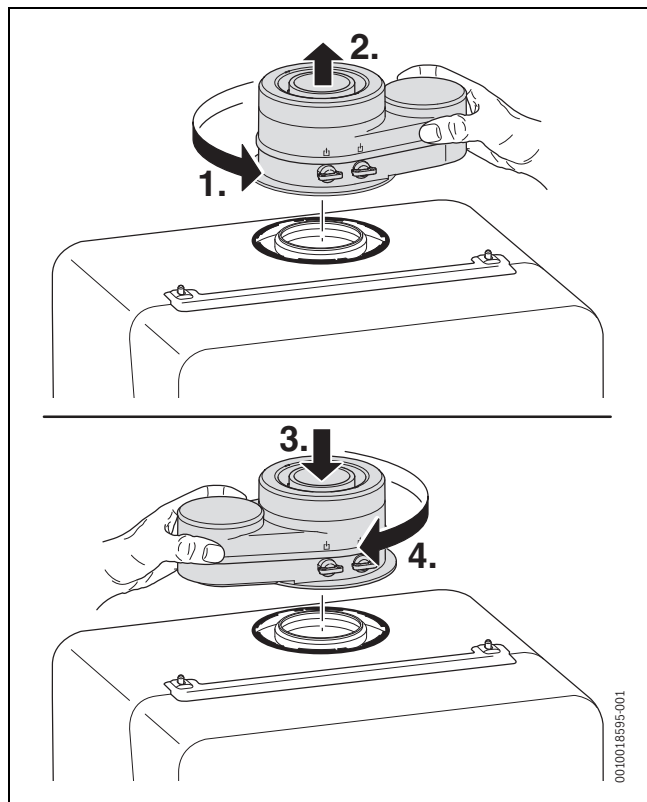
Ruotare l'adattatore per condotto gas combustibili
